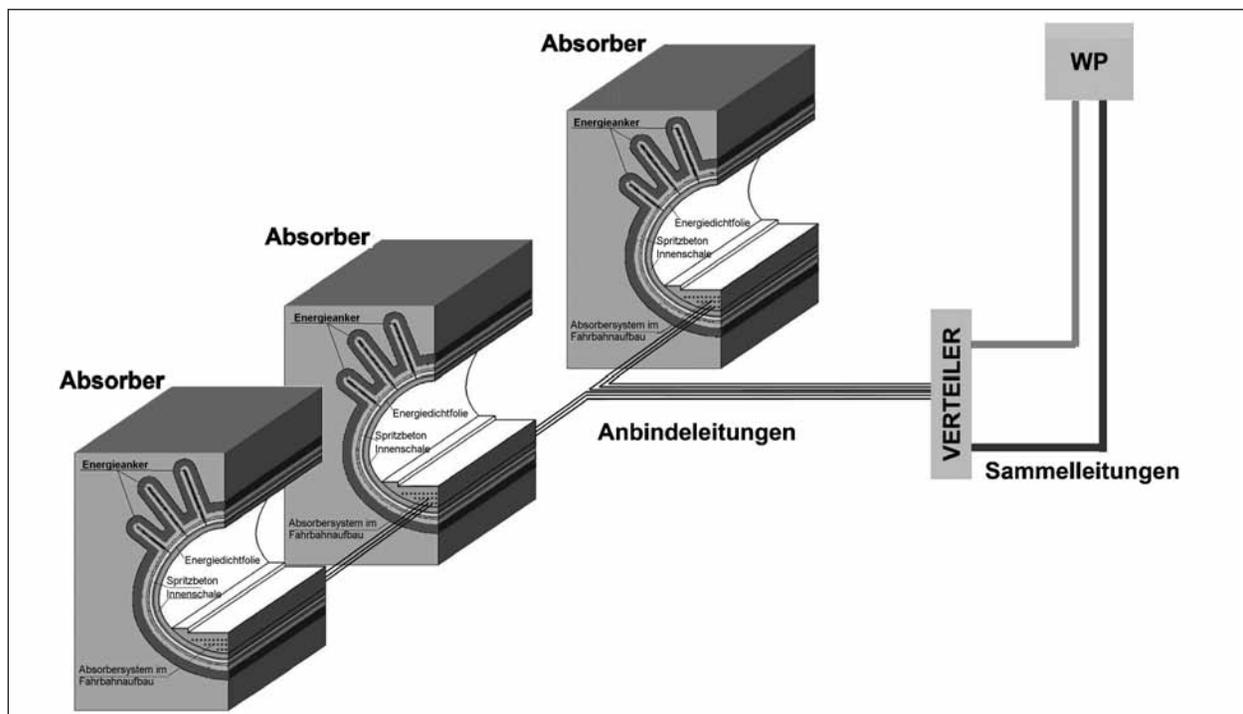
Beispielhafter Aufbau einer Tunnelthermie-Anlage bei einem in geschlossener Bauweise errichteten Tunnelbauwerk. Die Anbindeleitungen zu den einzelnen Absorberelementen werden in der Tunnelsohle geführt und an zentraler Stelle an den Verteiler (z. B. in einem Querschlag situiert) angeschlossen. Vom Verteiler verlaufen die Sammelleitungen bis zum Abnehmer, wobei die Sammelleitungen beispielsweise über separat hergestellte Vertikalbohrungen bis an die Geländeoberfläche geführt werden
